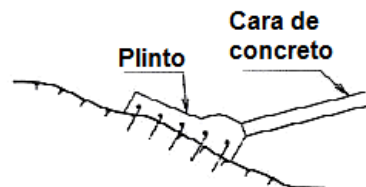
PLINTO INCLINADO (MACHADINHO)
